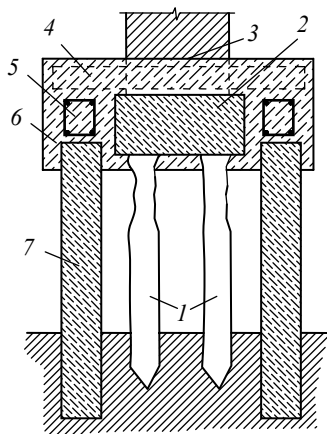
Вариант усиления свайных фундаментов выносными сваями:
